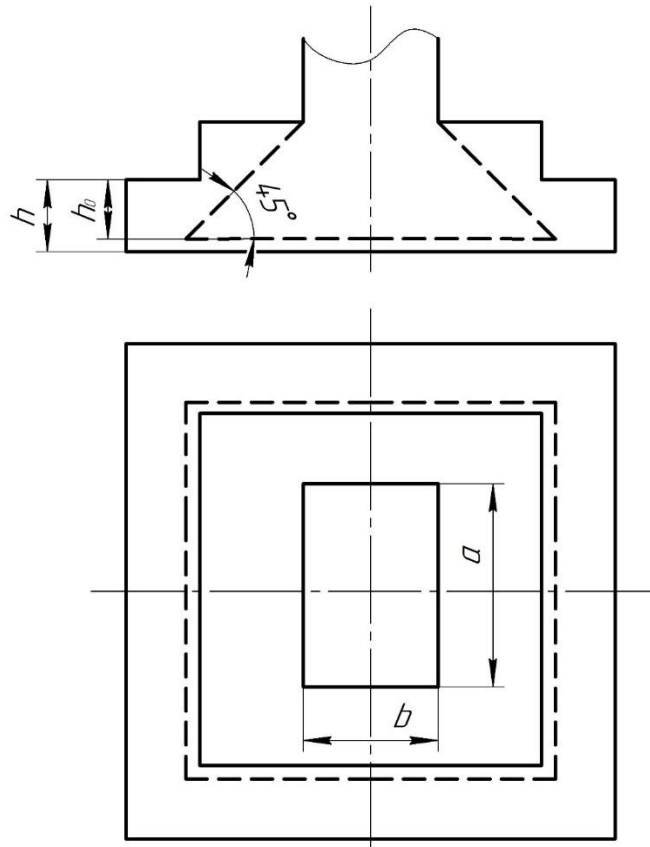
Схема для розрахунку продавлювання монолітного фундаменту під колону
